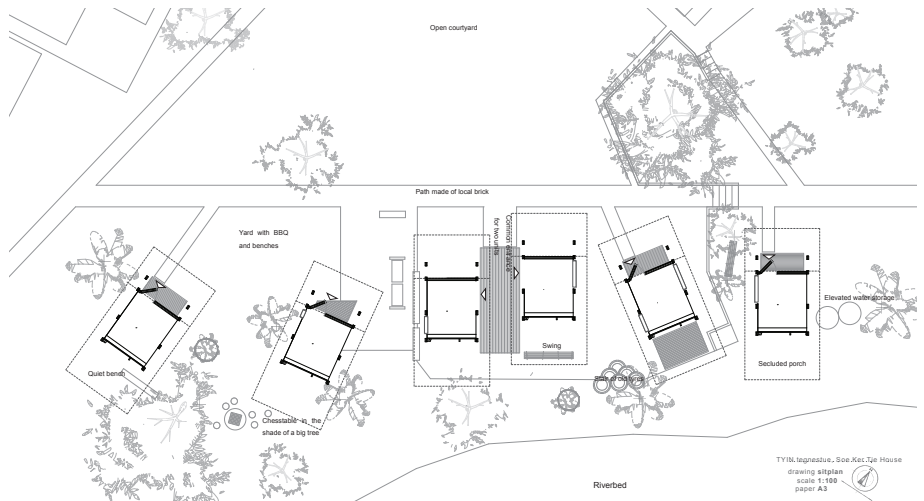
Disposición en planta de las 6 unidades dormitorio
